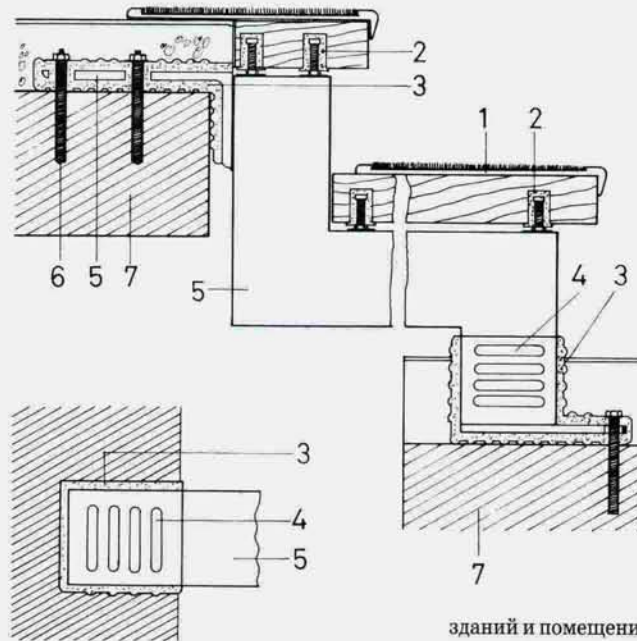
Упругое (амортизационное) соединение лестницы с металлической конструкцией перекрытий обладает средними звукопоглощающими качествами
